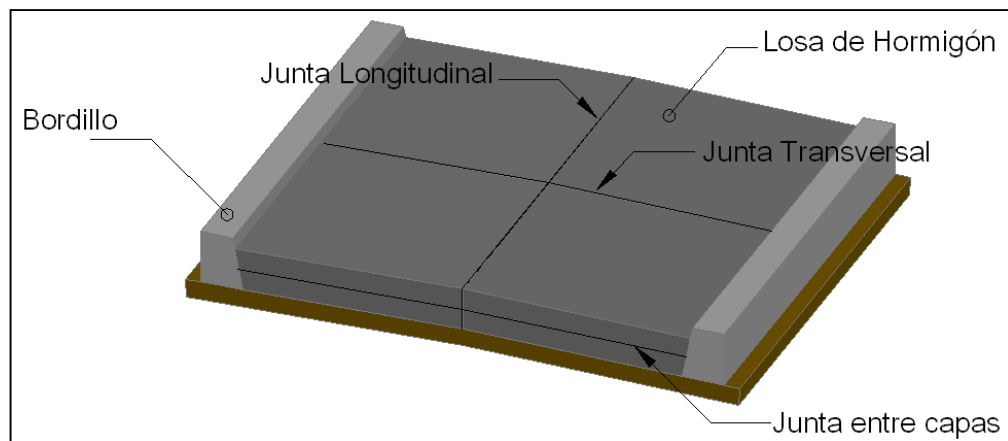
Esquema de Juntas longitudinales, transversales y entre capas
